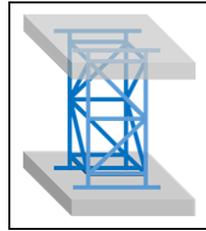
Konstruktion senkrechttes Raumfachwerk aus Holz
